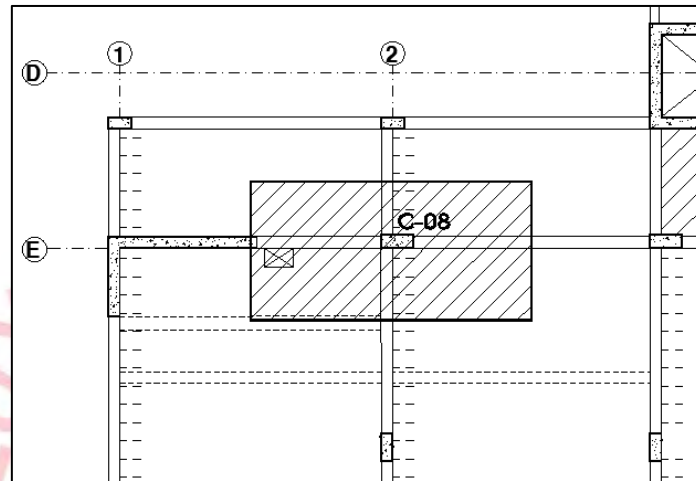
Área del techo que carga la columna C-08.
